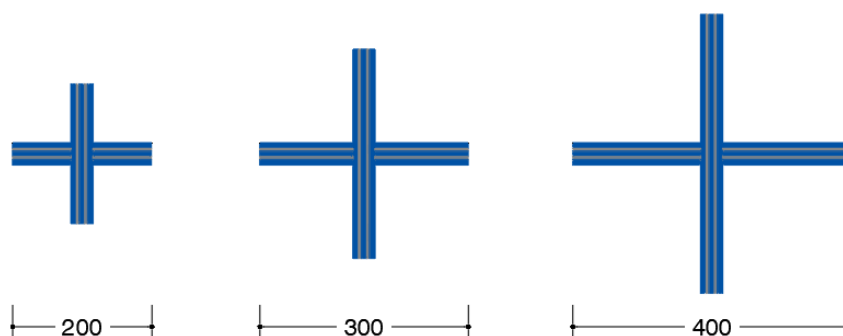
Secções dos pilares em vidro laminado adotadas e espessuras de vidros variáveis (dimensões em mm)
